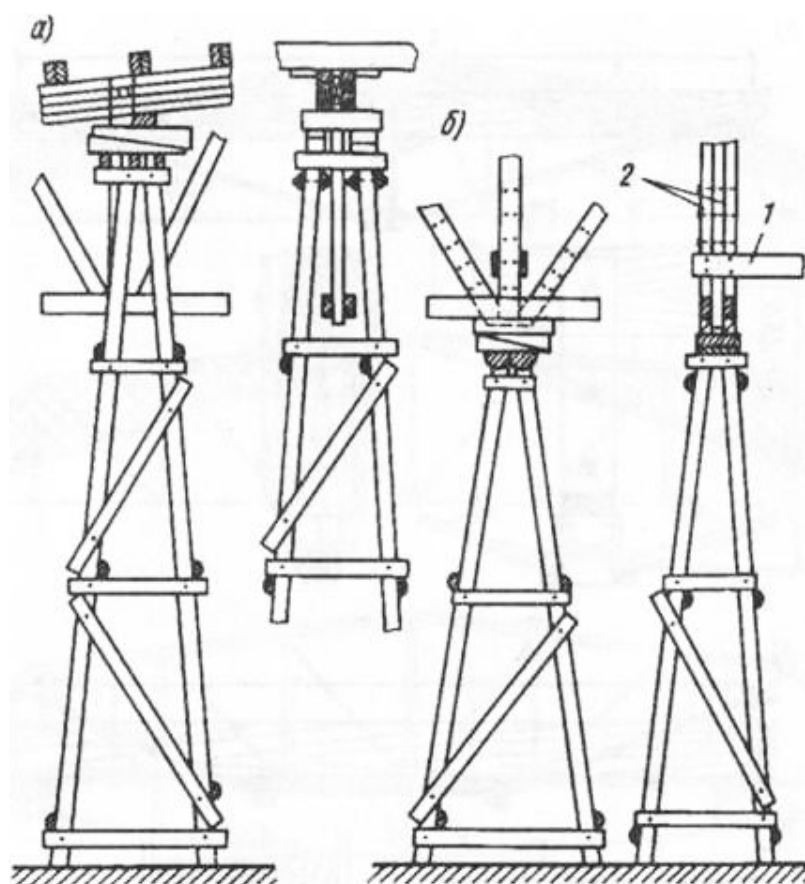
Временные опоры башенного типа: а — подпираание верхнего пояса фермы; б — подпираание нижнего пояса;
